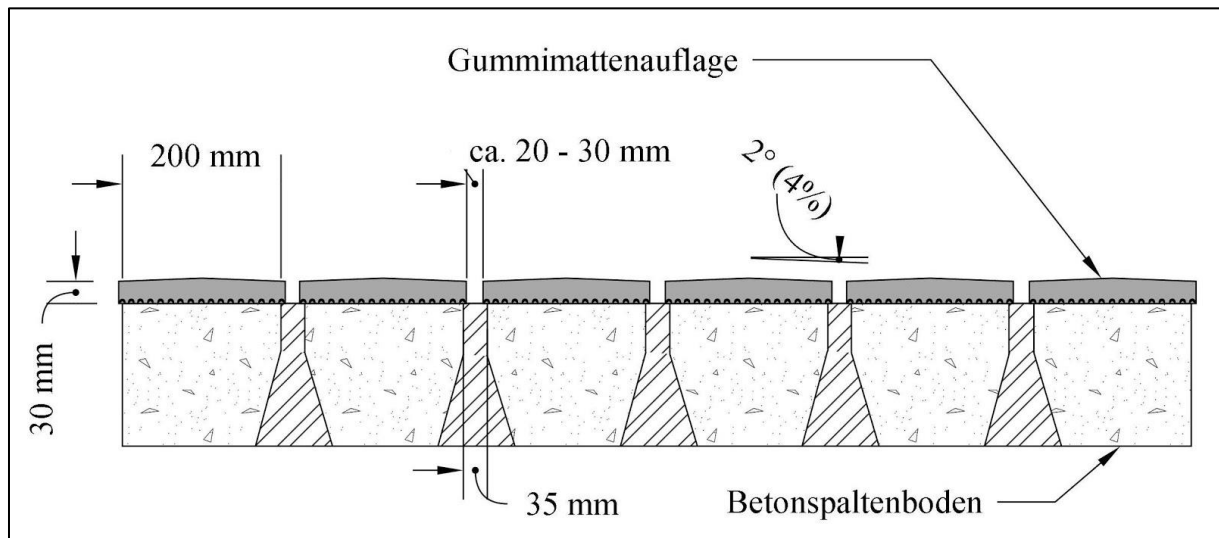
Konventioneller Spaltenboden mit harnableitender Gummimatte durch dachförmiges Gefälle (verändert nach Fa. Kraiburg Elastik GmbH)
